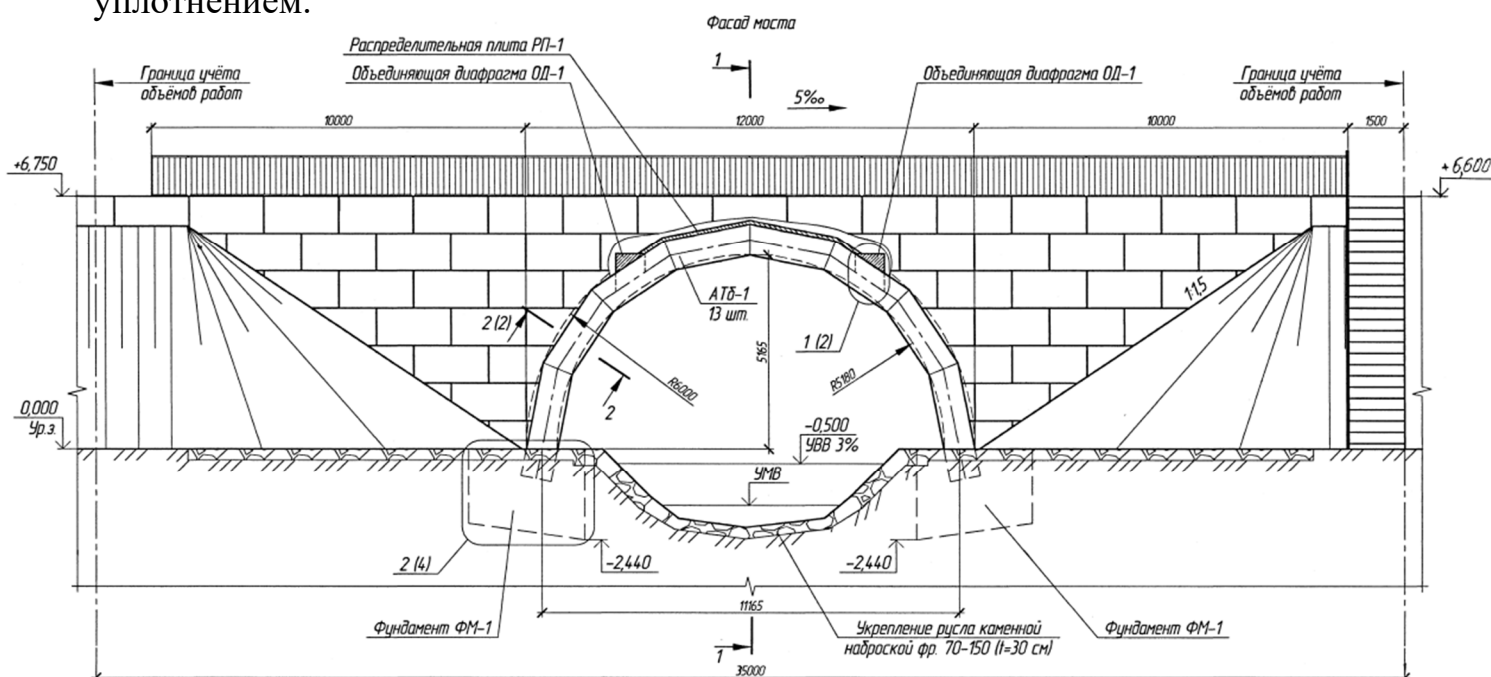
Грунтозасыпной мост в теле насыпи. Фасад моста.
